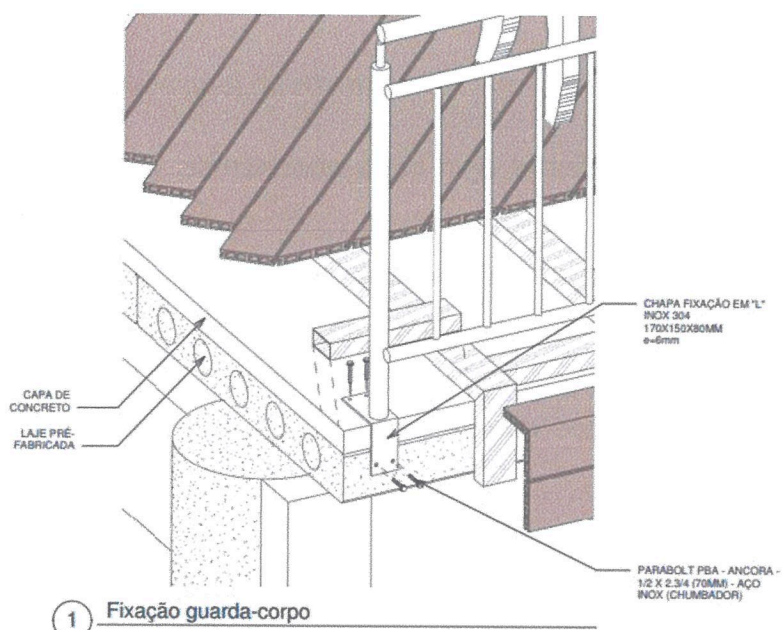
Detalhes do Guarda-Corpo - Fixação.
